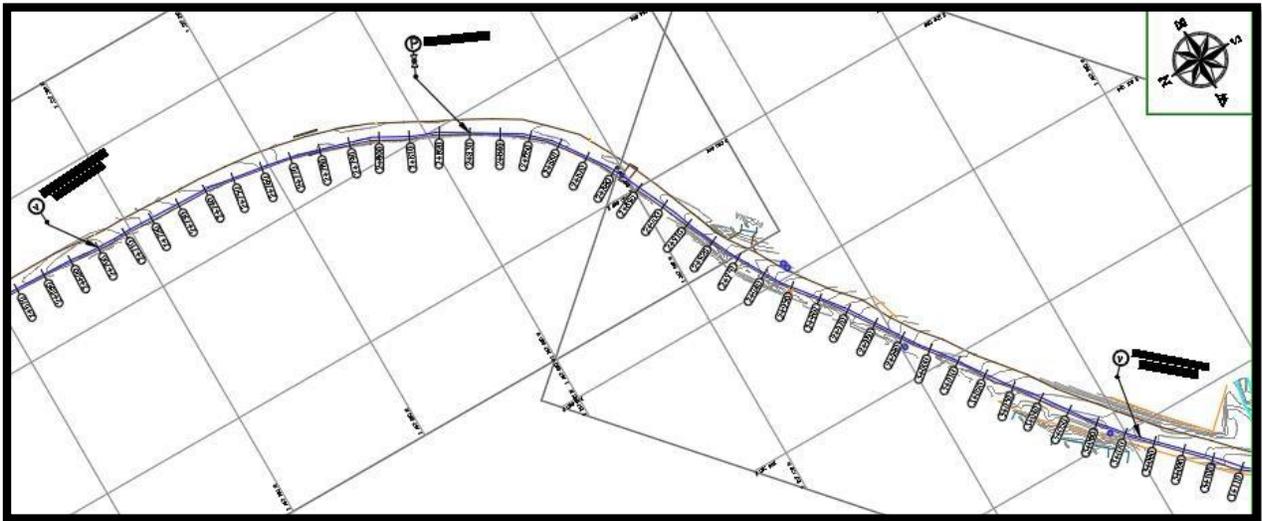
Plano general tramo #11. Fuente: WOPS hydraulic Cúcuta.
